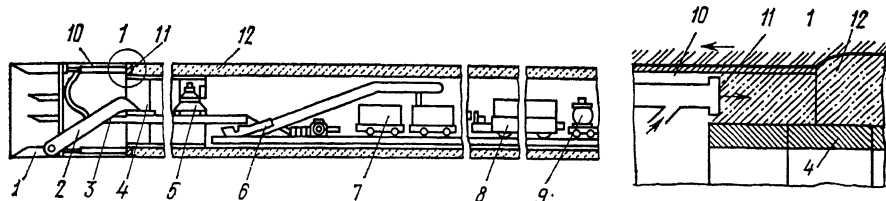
Схема сооружения тоннеля щитом с обделкой из монолитно-прессованного бетона:
